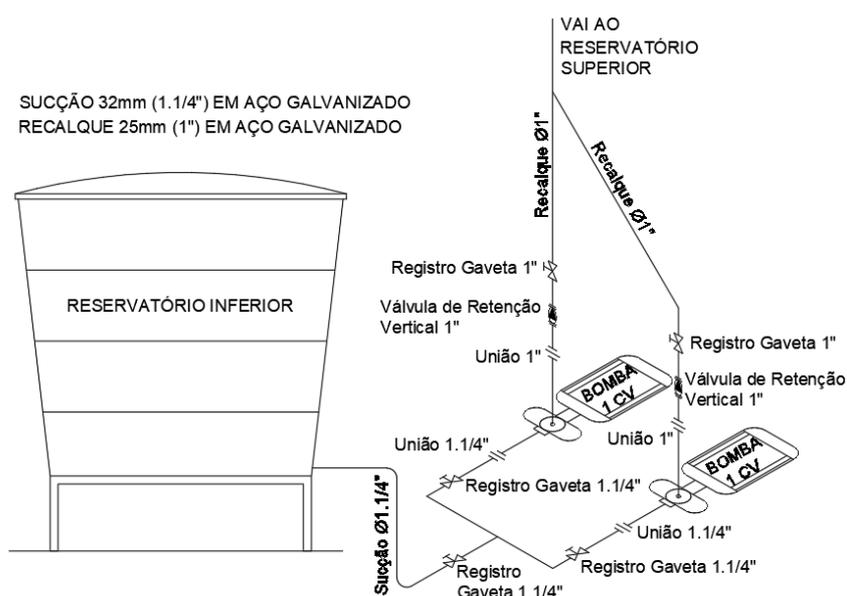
Detalhe com as instalações do conjunto moto-bomba.
